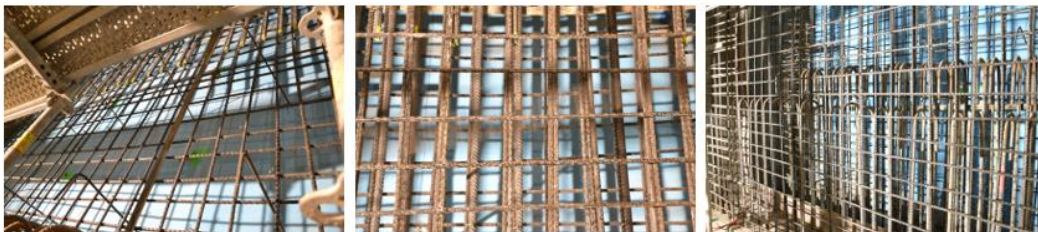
Bewehrungseinbau in der vorgesehenen Öffnung mit erdseitiger (links) und luftseitiger BFVK-Bewehrung (mittig) sowie Anschlussbereich (rechts)
